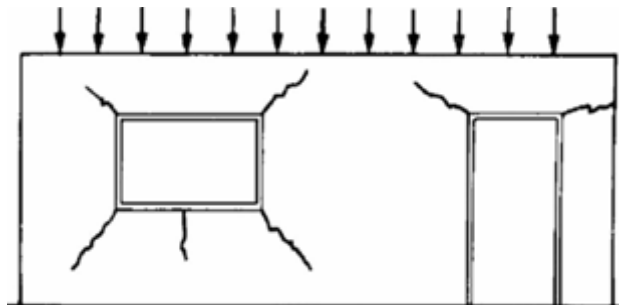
Fissuras causadas por carregamento excessivo de compressão.
